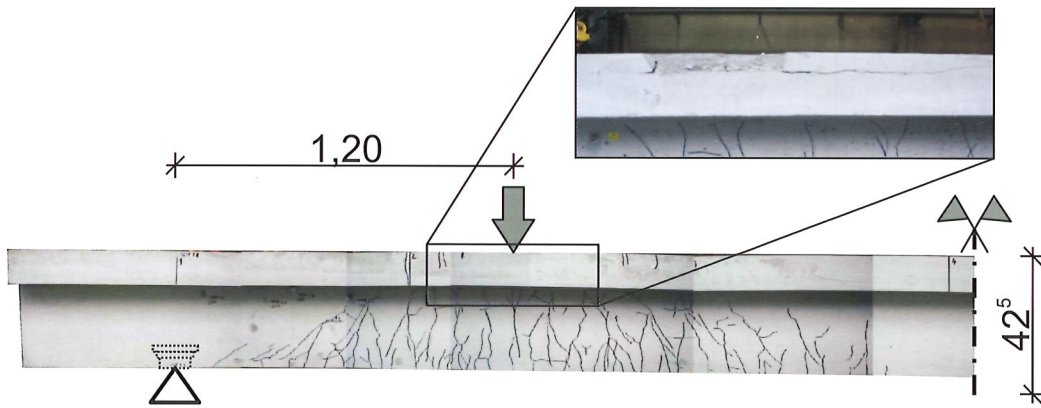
Plattenbalken: Rissbild und Bruchzustand (Versagen der Betondruckzone) [24]
